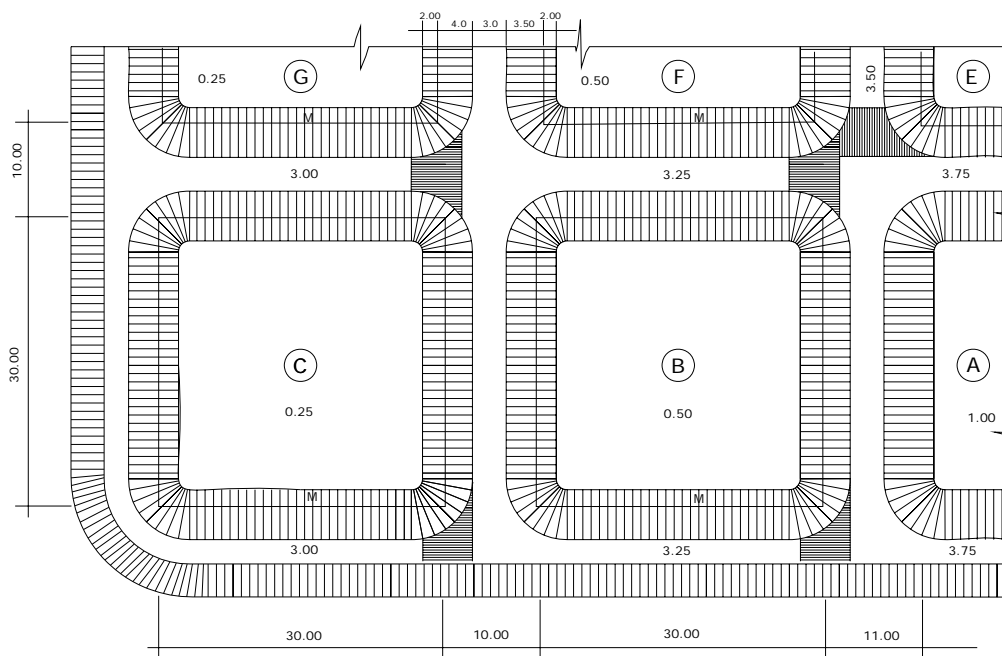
Vista en planta de los diques y de las Lagunas B y C.
